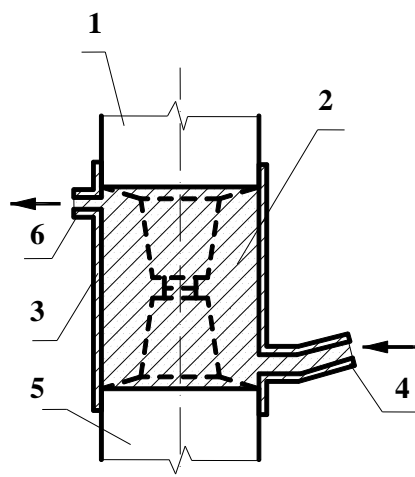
Betonarea rosturilor coloanei cu beton cu granulație fină, utilizând metoda ascendentă de injectare a amestecului de beton:
